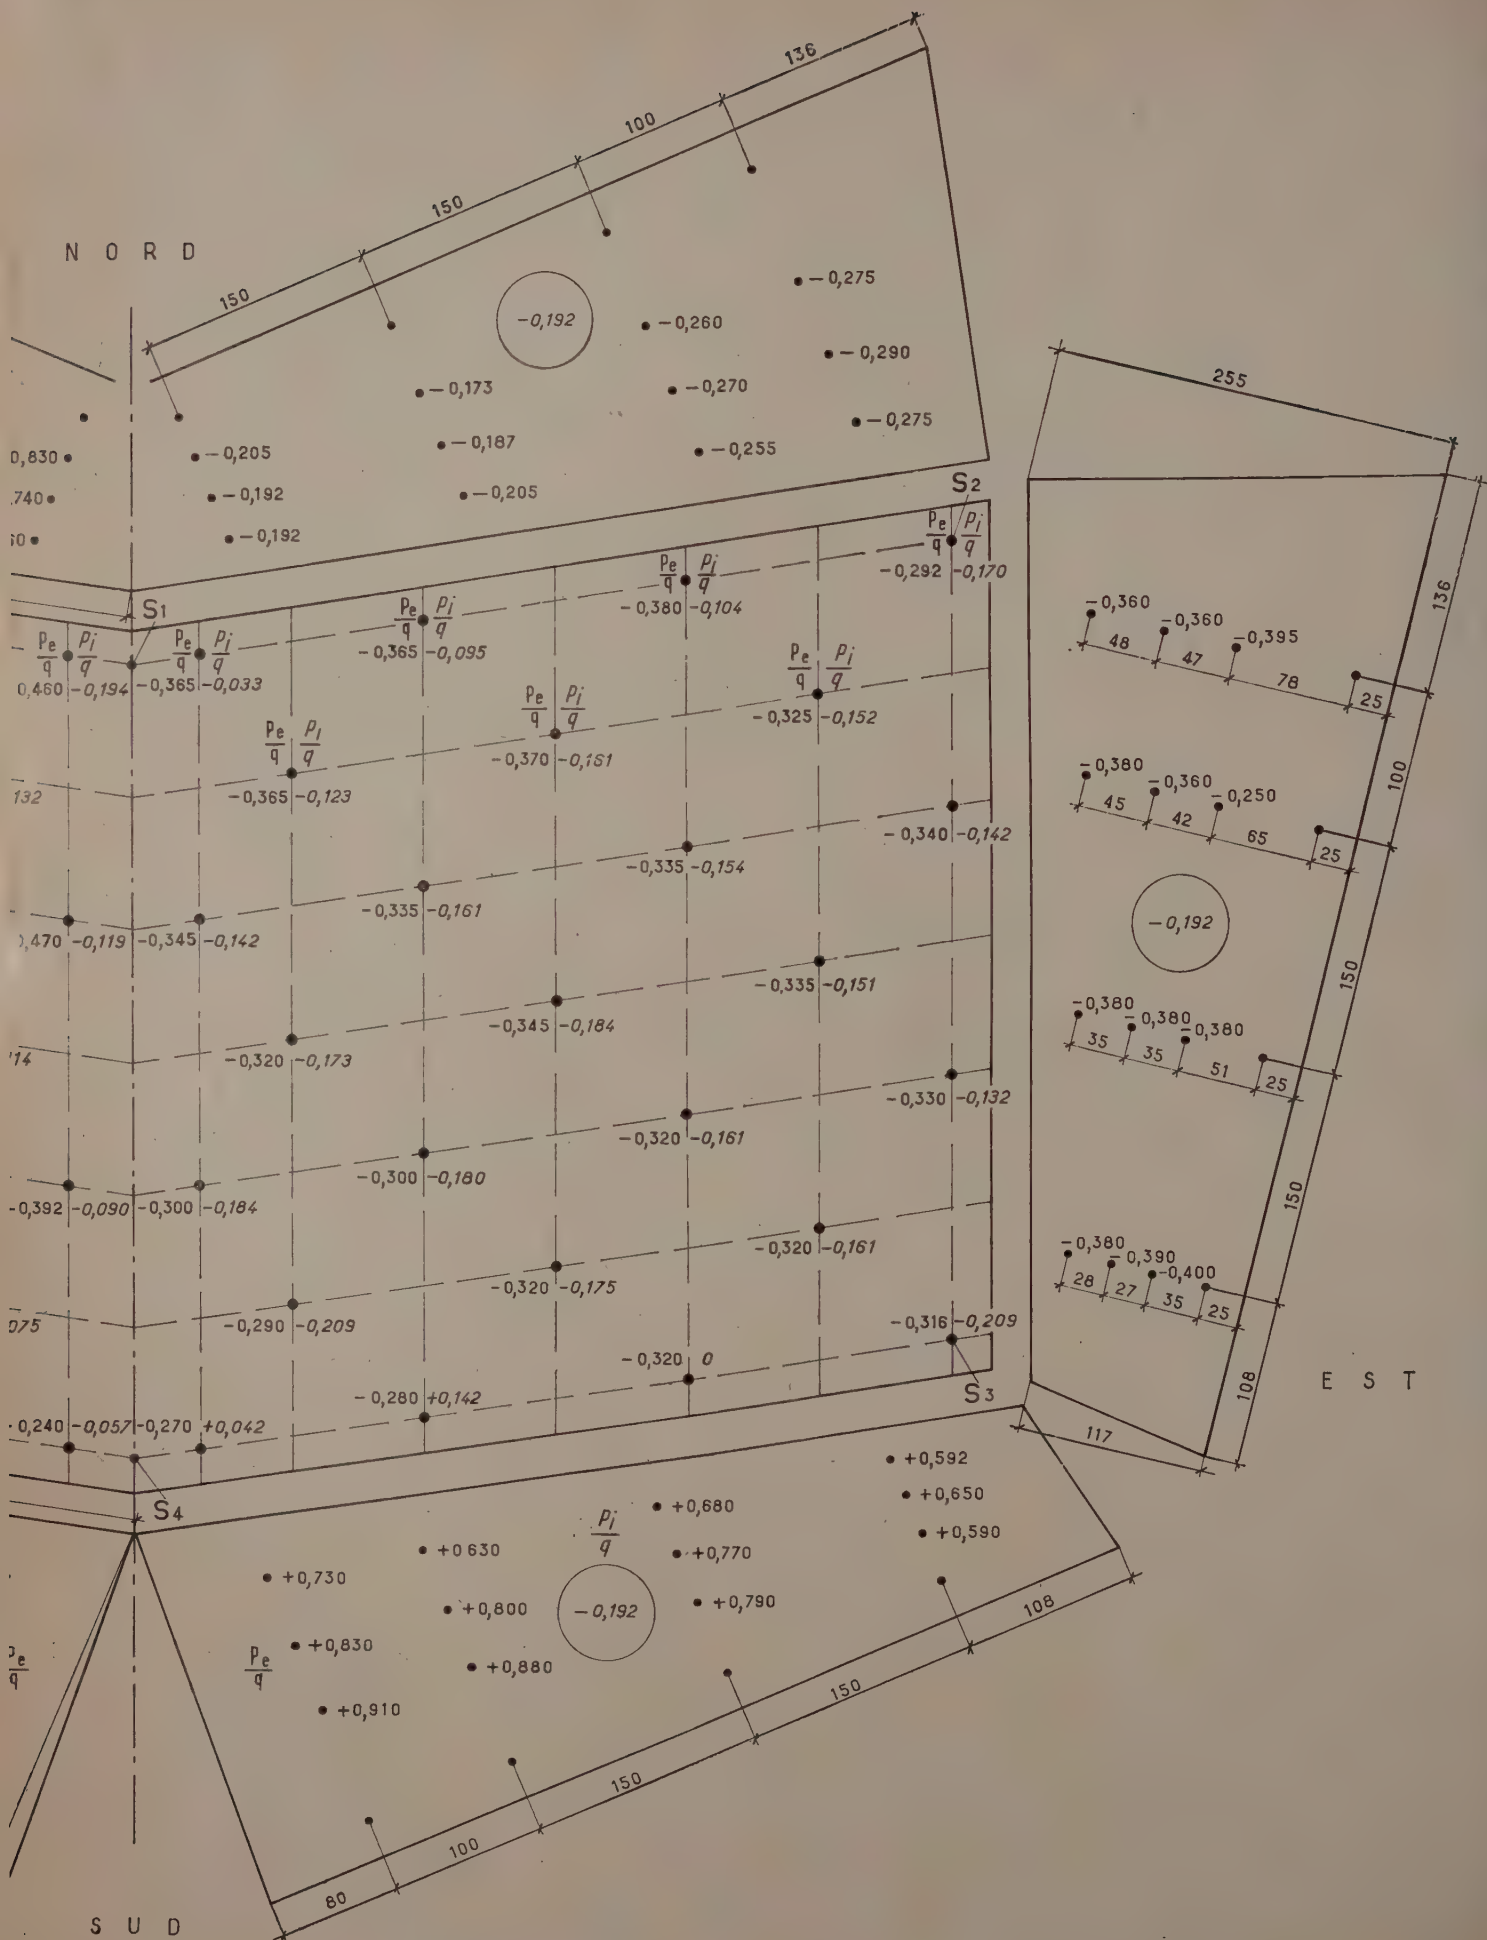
Bâtiment avec signal. La toiture et les façades
